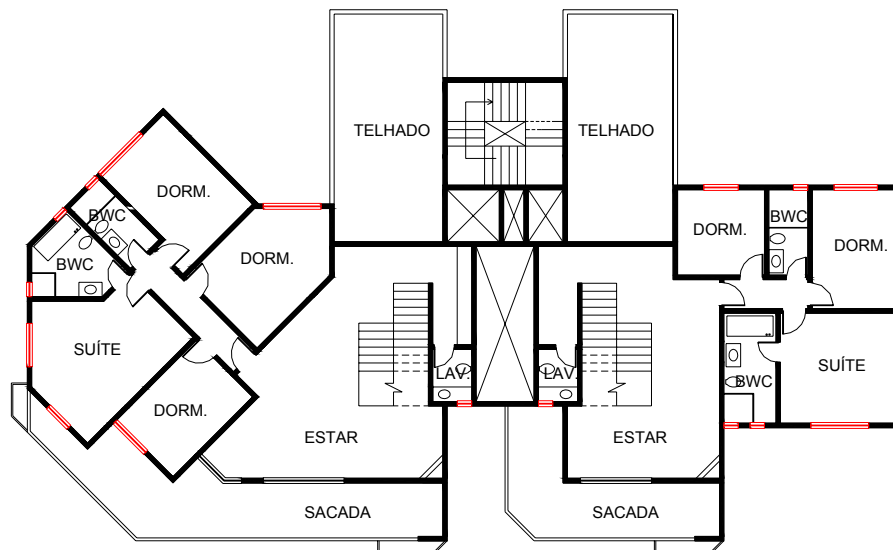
Planta Baixa do 9º pavimento do Estudo de caso C (Apartamento Triplex).
